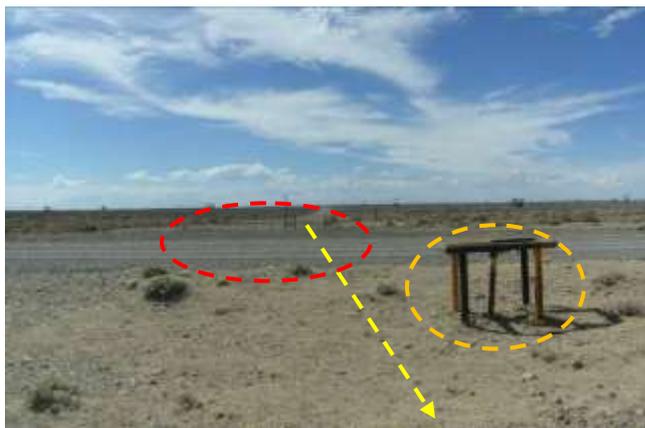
Emplazamiento de gasoducto Cruce con Ruta Provincial N° 37 (rojo). Se observa protector de válvula (anaranjado). Foto en dirección N.
